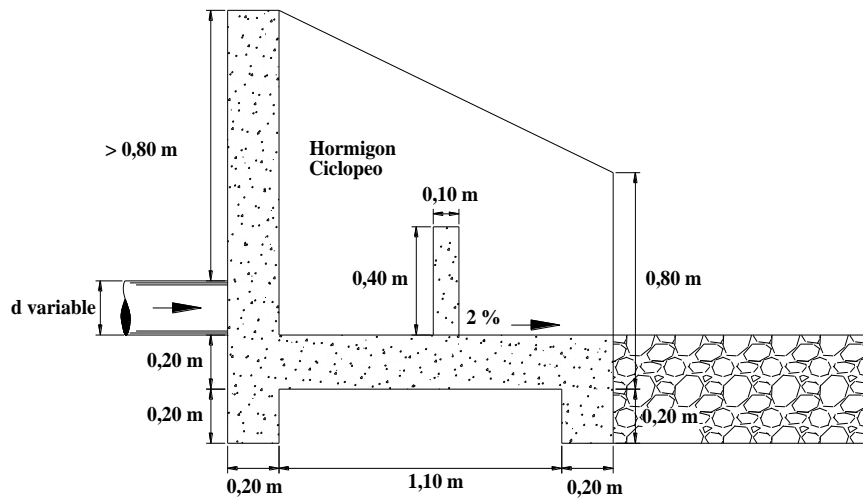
Corte de la Estructura de Hormigón para la Descarga
